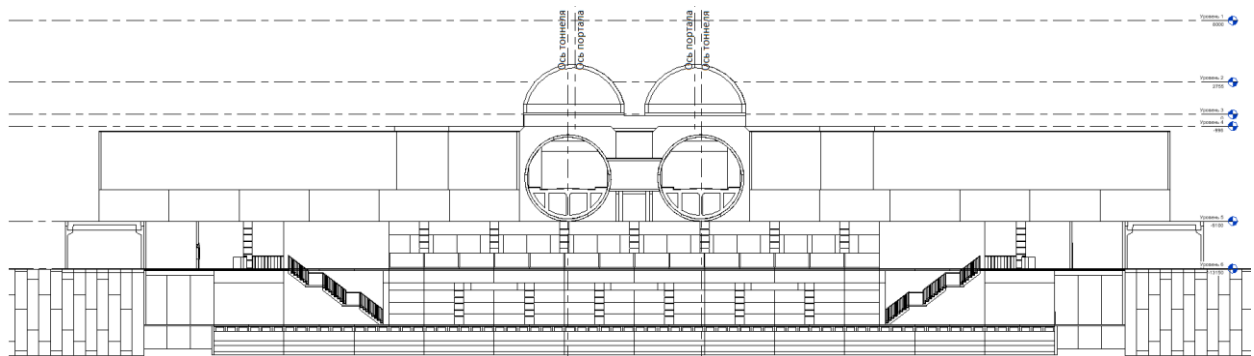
Архитектурно-планировочное решение (фасад - западный)
